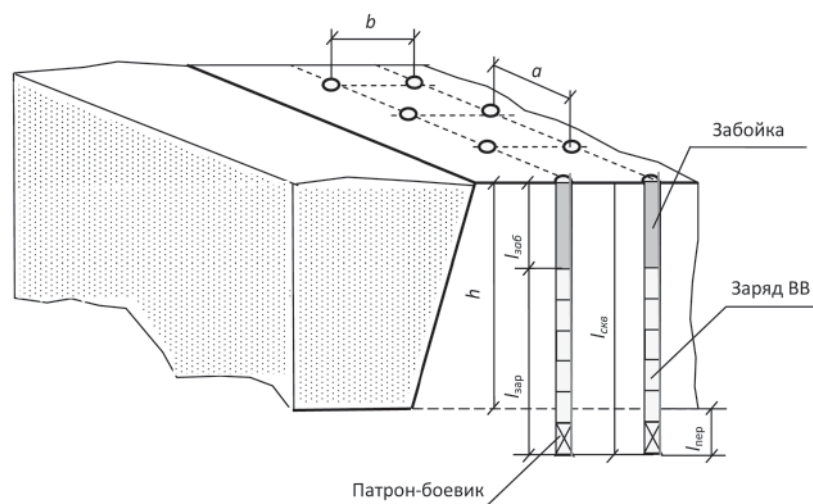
Схема расположения шпуров и конструкций шпуровых зарядов
